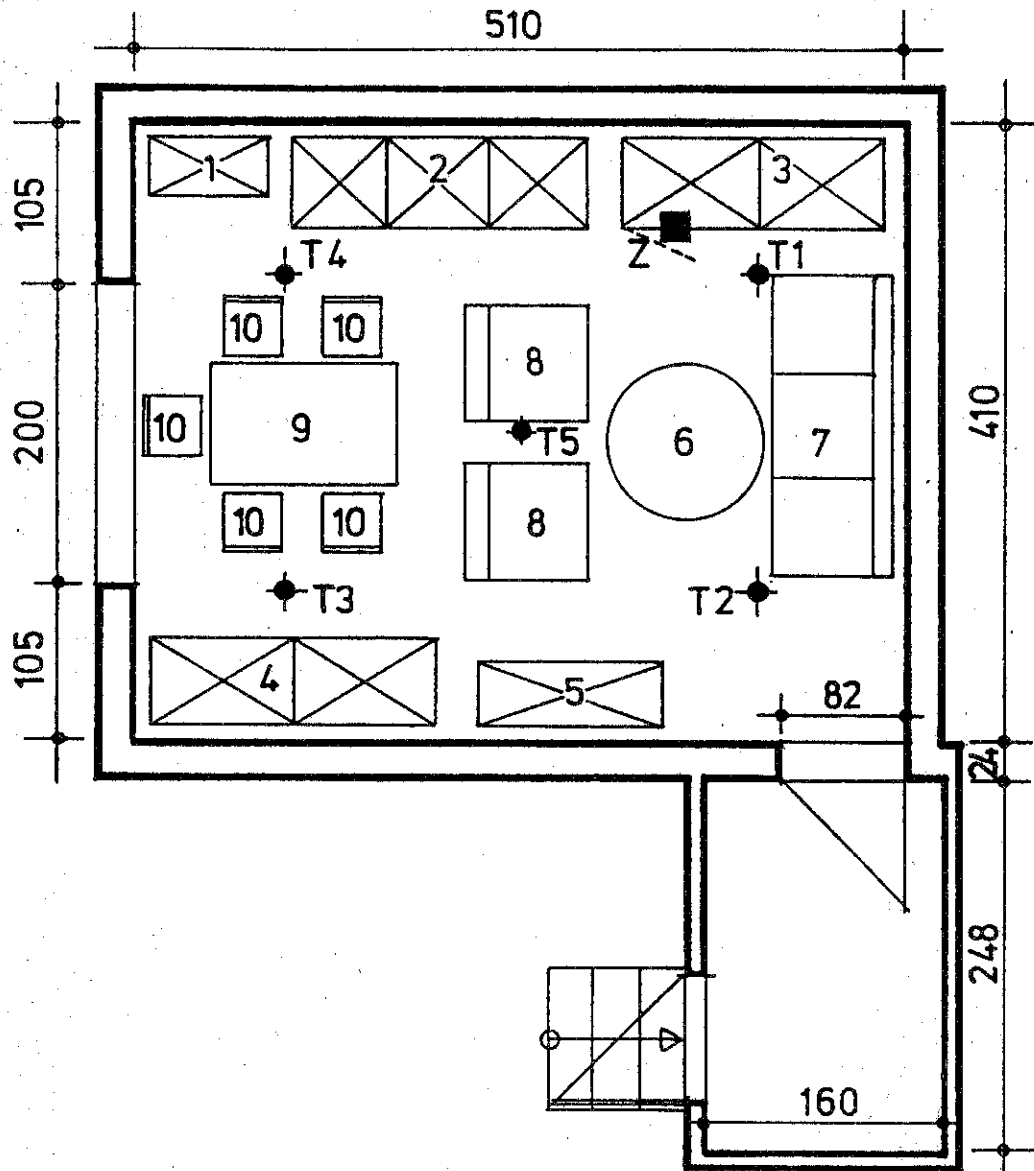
Brandraum mit 22 m² Grundfläche als Wohnraum eingerichtet
